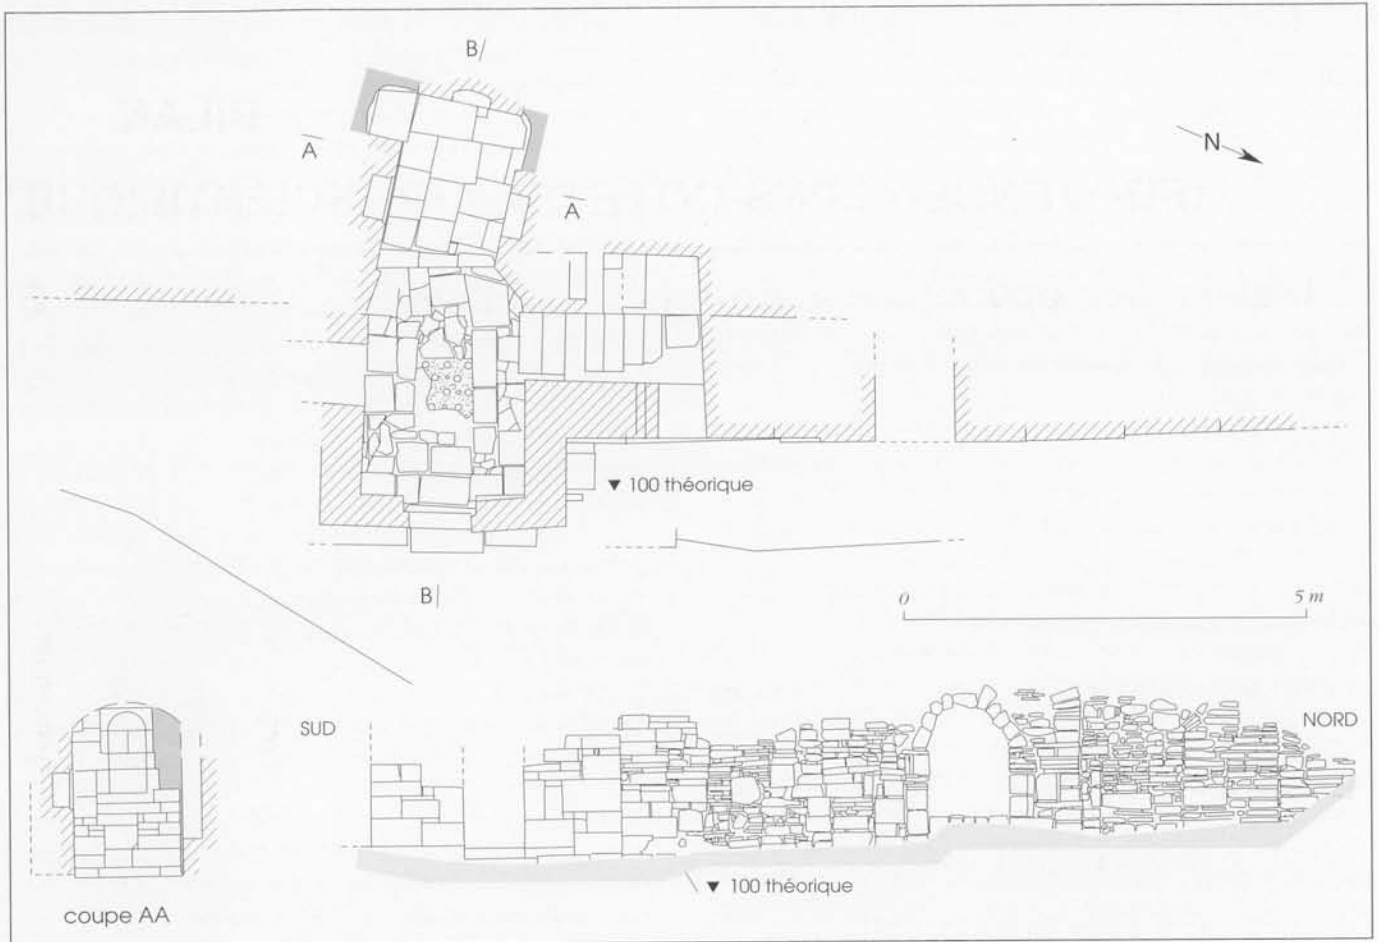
VENASQUE, les Souveilles. Plan et relevé de façade de la construction moderne.
